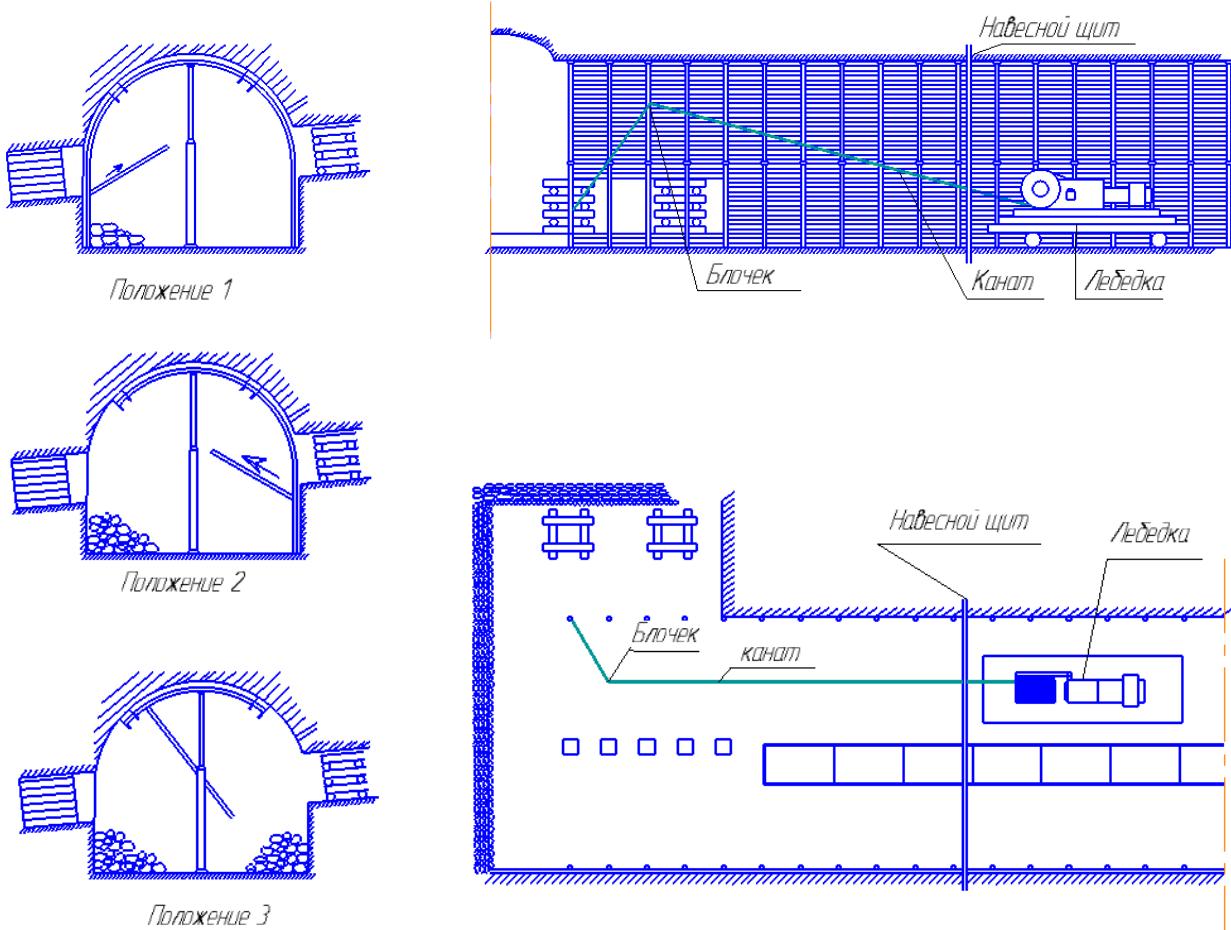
Схема извлечения металлической арочной крепи при разборке завала
